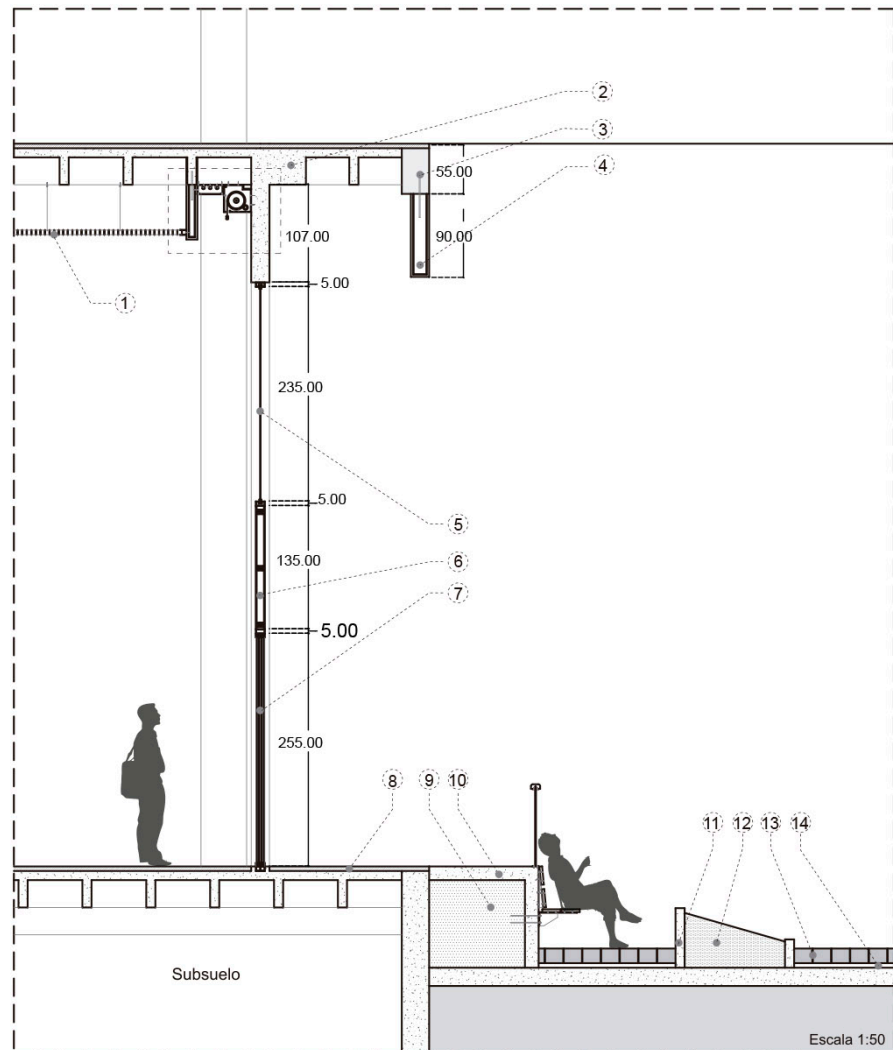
Detalle constructivo corte de ventanal de salón de usos múltiples
